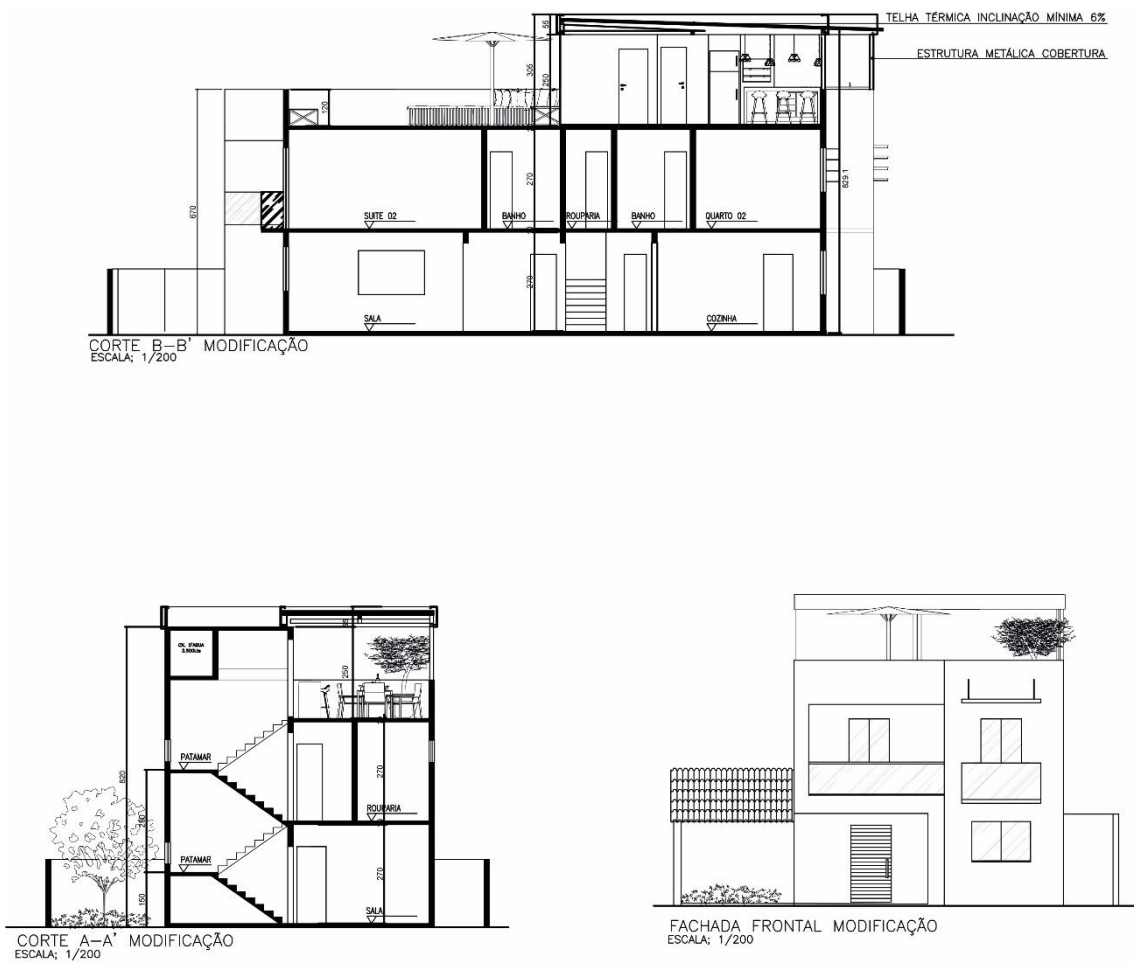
Cortes e fachada após a proposição final de intervenções
